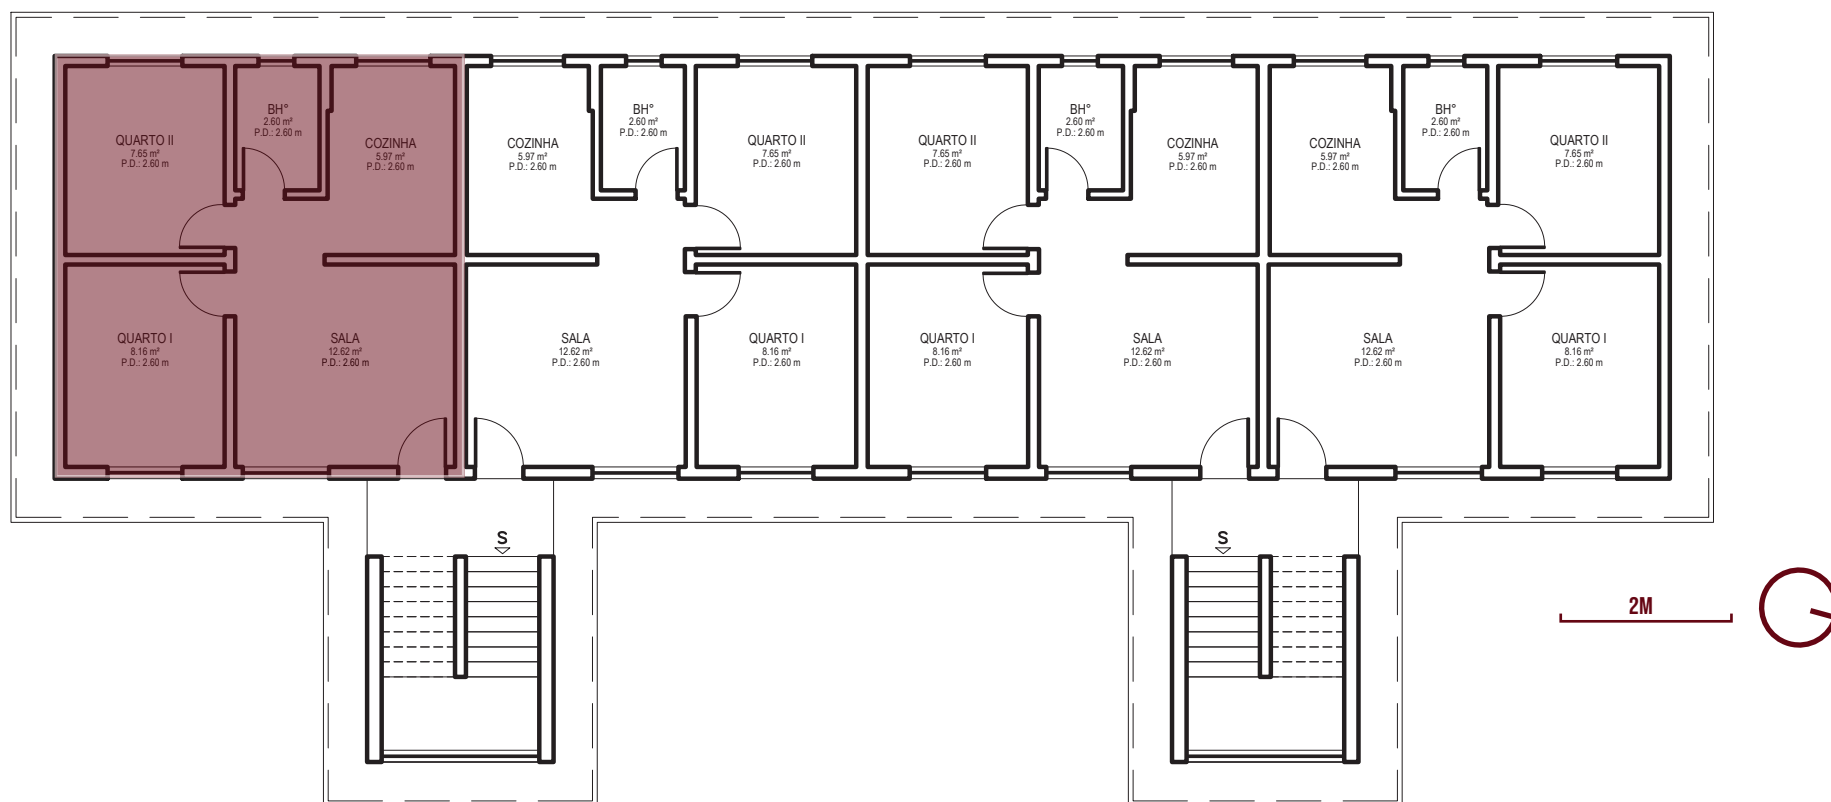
PLANTA DO PAVIMENTO TIPO DO OBJETO DE ESTUDO
